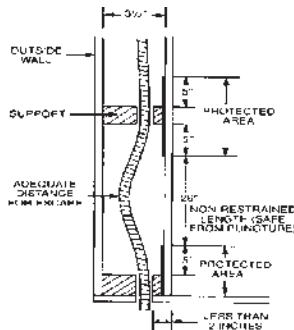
Vue de dessus d'une conduite horizontale non soutenue
